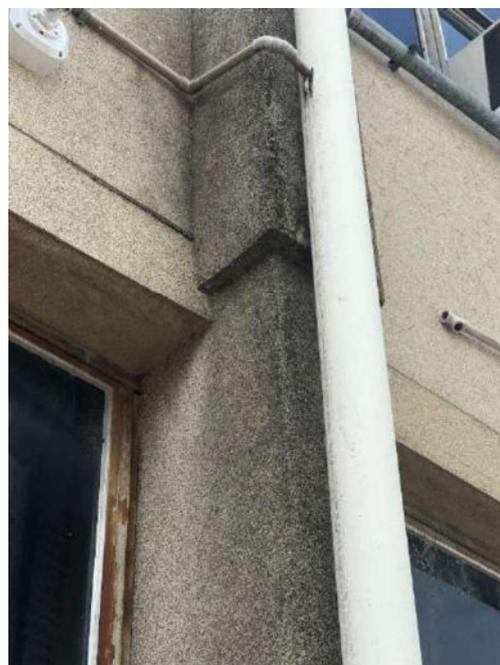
Detalhe - Presença de mofo/bolor, deslocamento do concreto de cobrimento entre a viga e alvenaria
